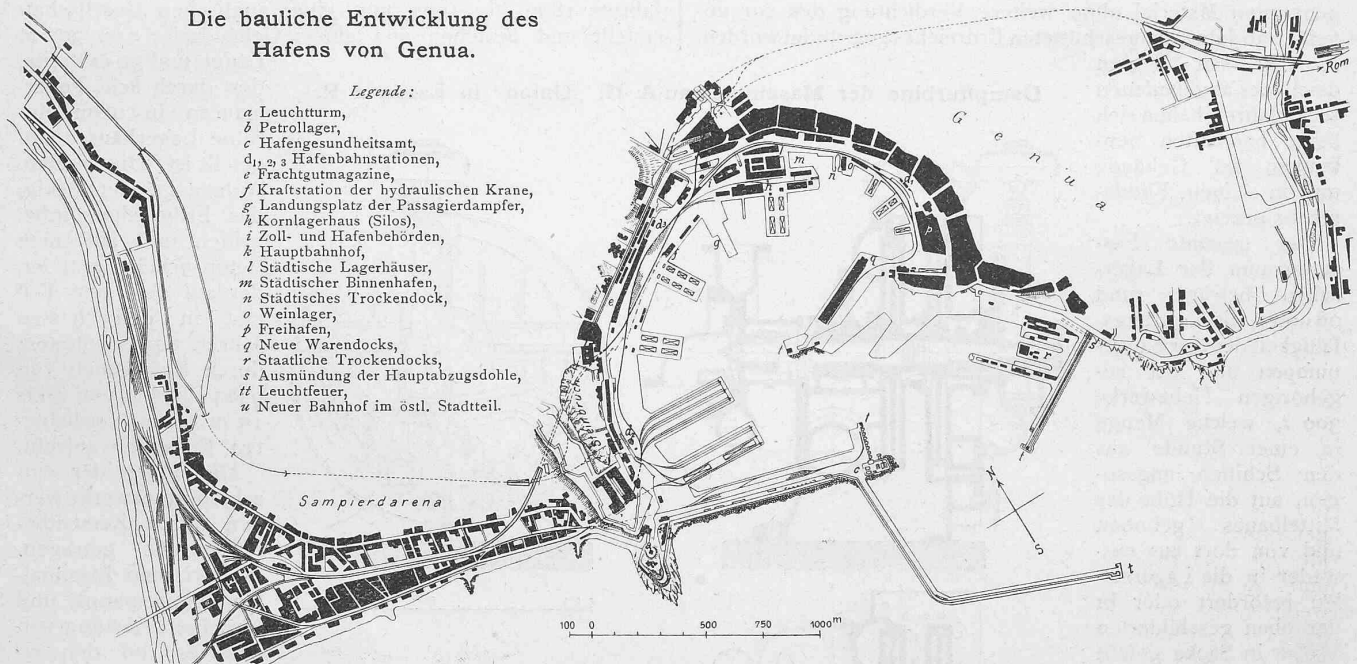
Lageplan des Hafens im Jahre 1904. — Masstab 1 : 30 000.
